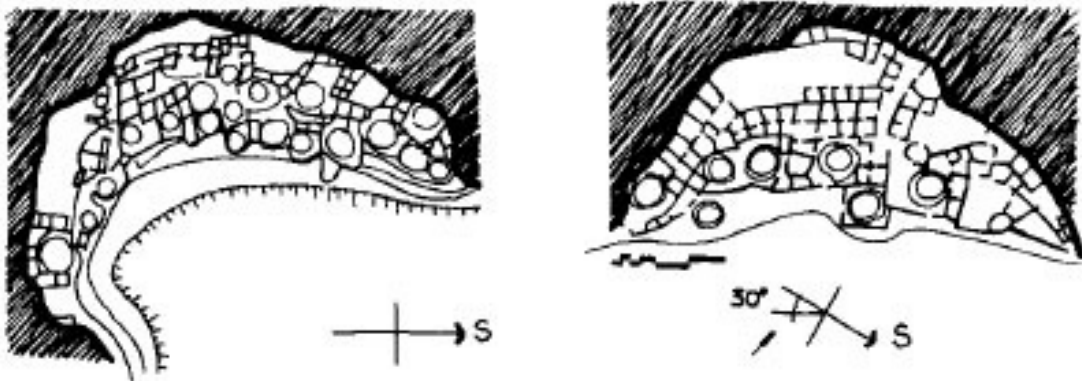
Plantas esquemáticas de aglomerado Pueblo.
